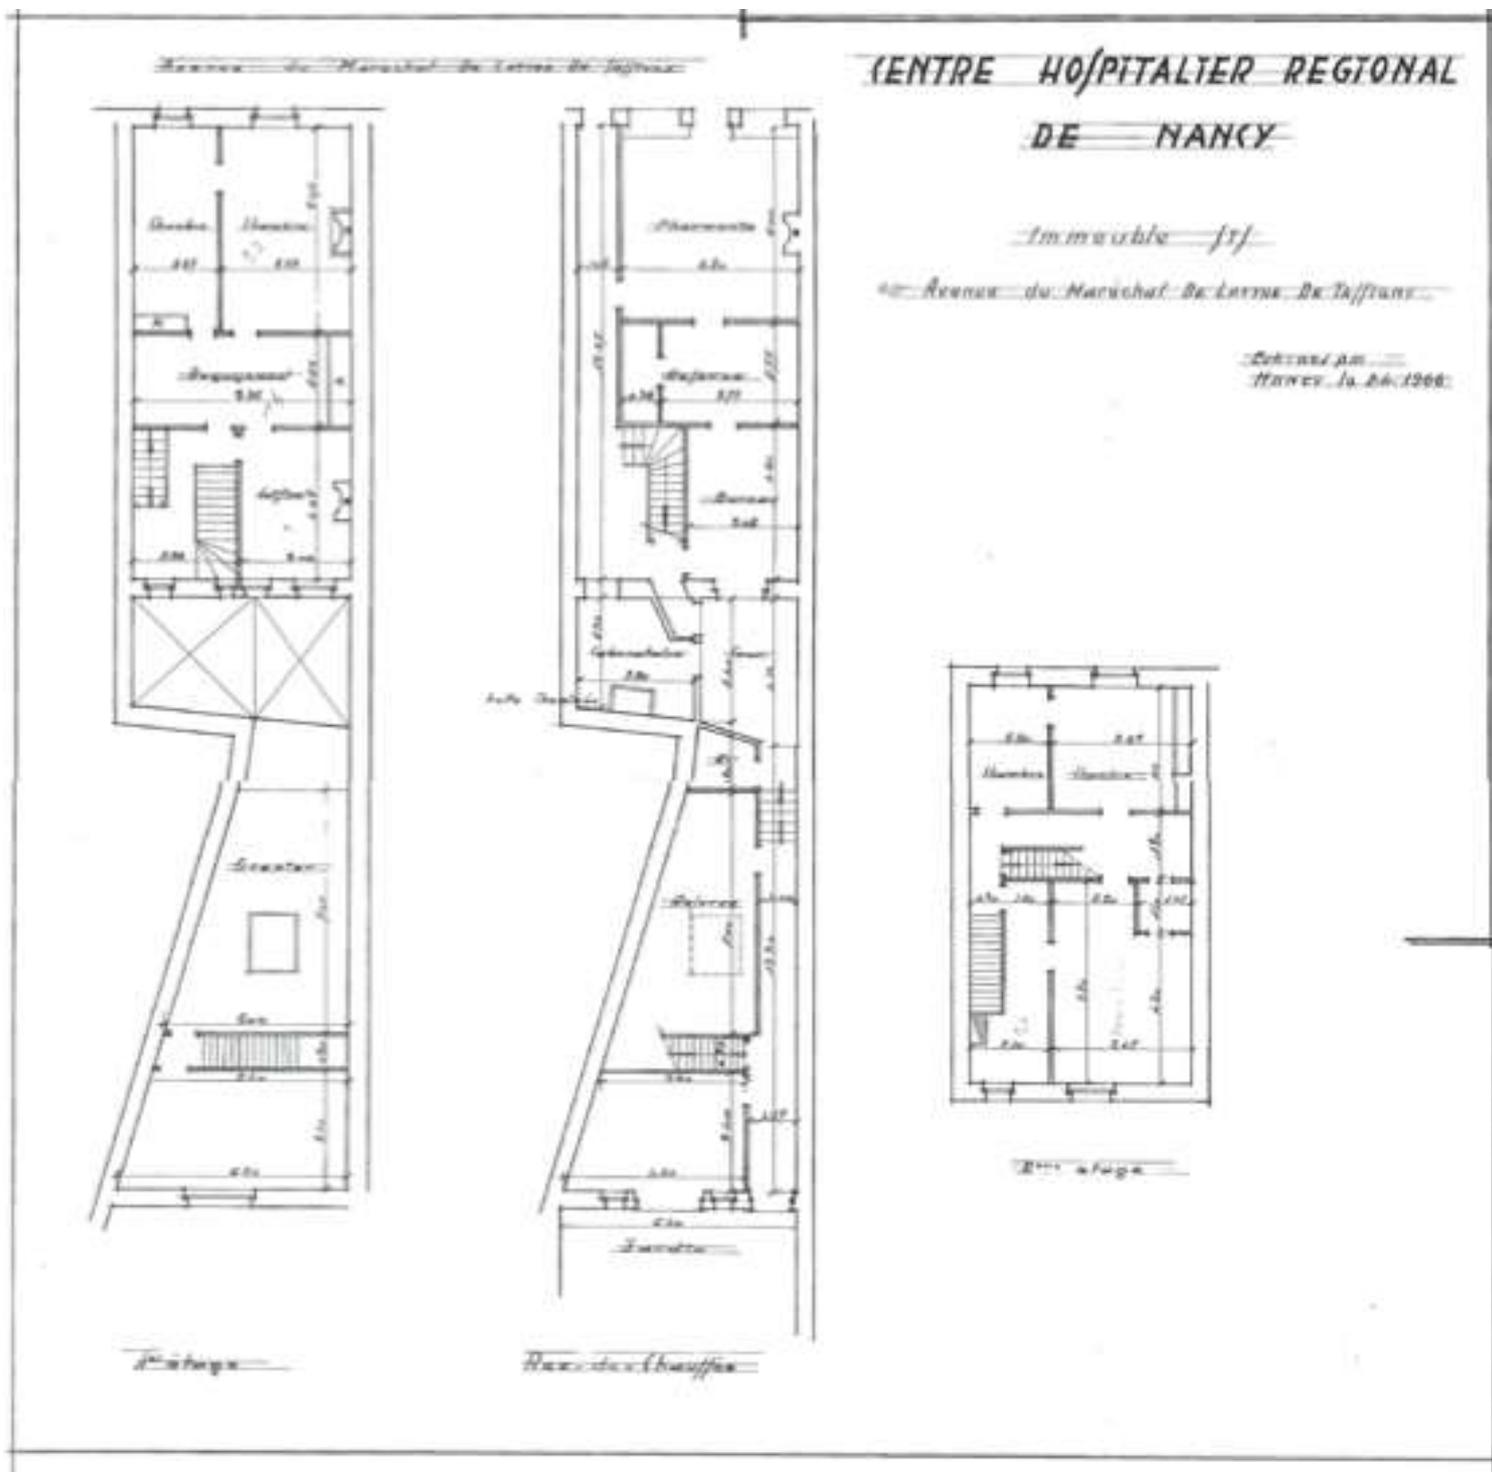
plan de la Pharmacie Saint Pierre en 1966
